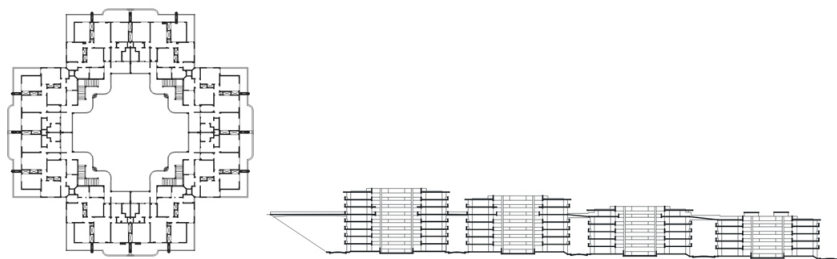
Lagoinha - 1944 - Belo Horizonte, MG. 928 unidades, blocos com pátio interno. Respectivamente planta Baixa e corte.
